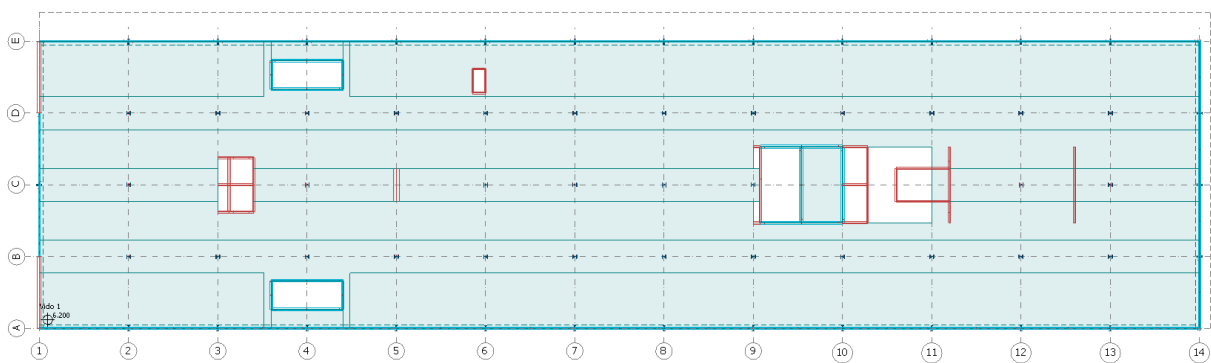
Utbedret endring av geometrisk utforming bærende konstruksjon alternativ 2, plan Vido 1.
